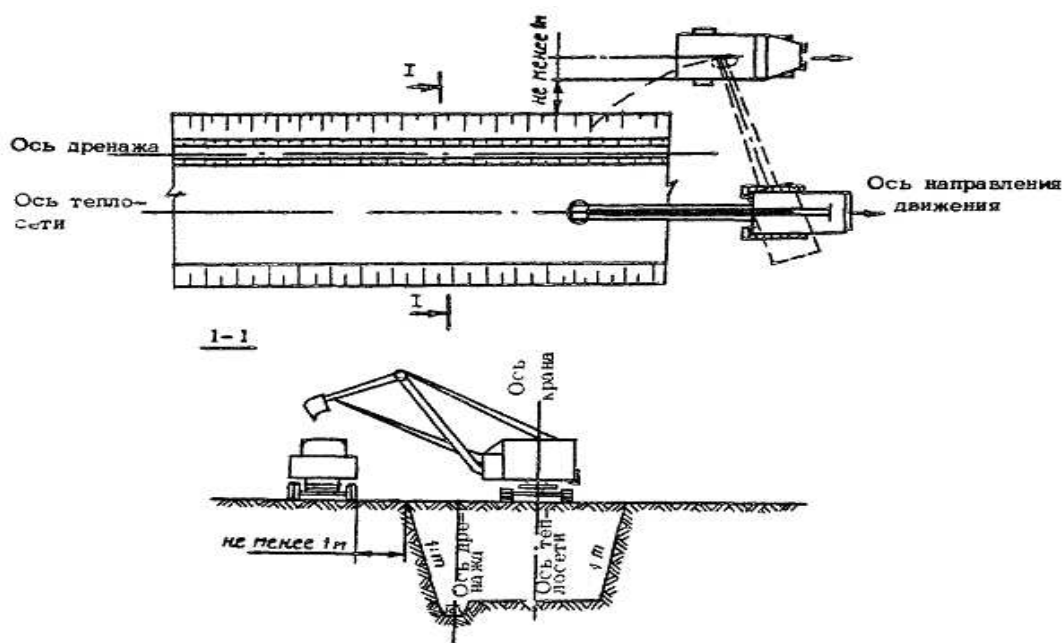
Разработка грунта для прокладки тепловых сетей
